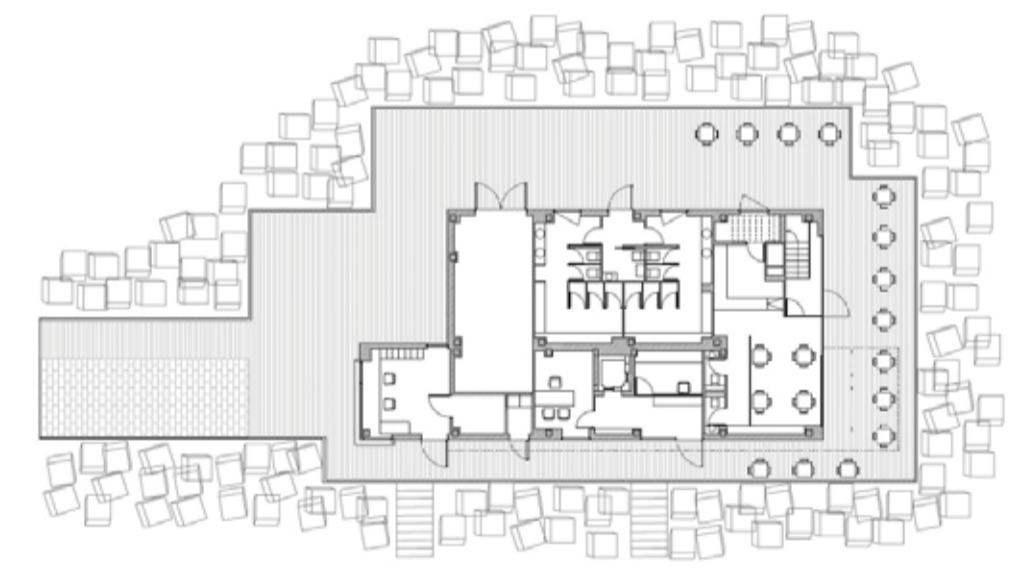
Planimetría Plantas Generales, Interior y Exterior - Edificio de Servicios Nautico Deportivo de Portonovo / www.plataformaarquitectura.cl
